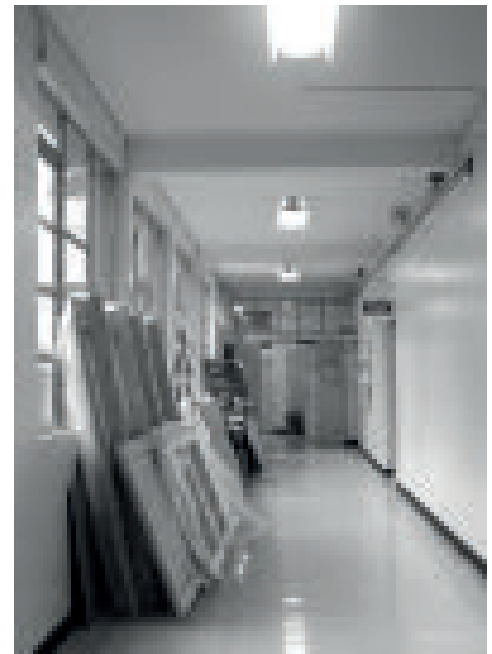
2016, Vista del pasillo del nivel -1, donde se destacan las vigas del entrepiso. Fotografía del autor.
